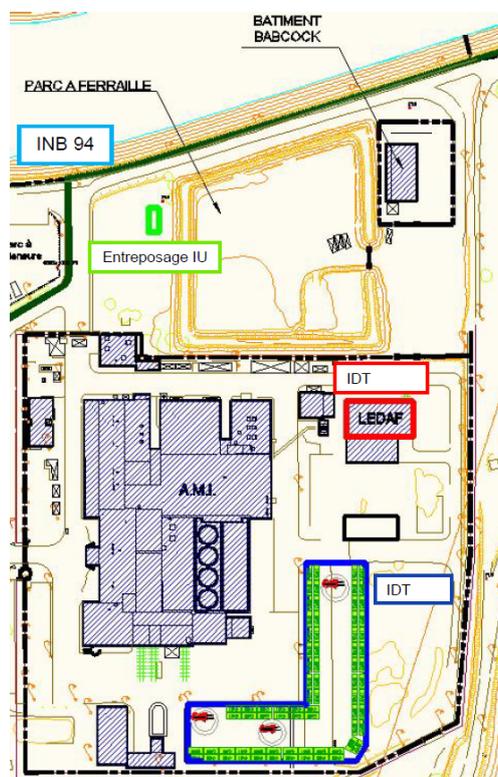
plan masse de l'installation (source : pièce 2 du dossier)
